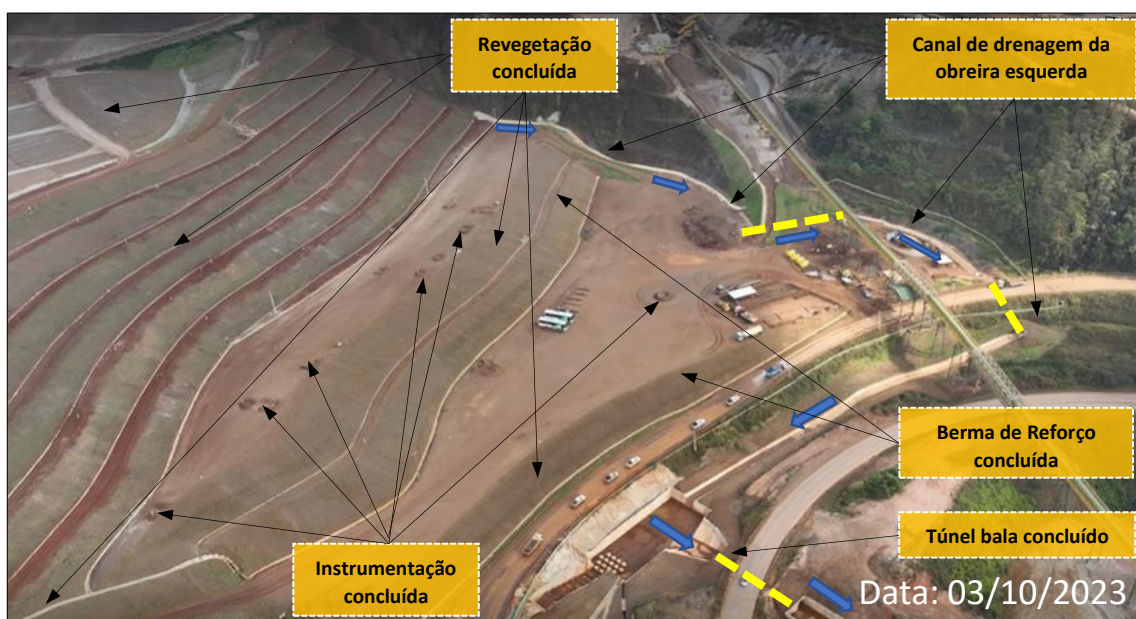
Canal da Obreira Esquerda, Berma de Reforço, Revegetação e Instrumentação (Obras Concluídas)
